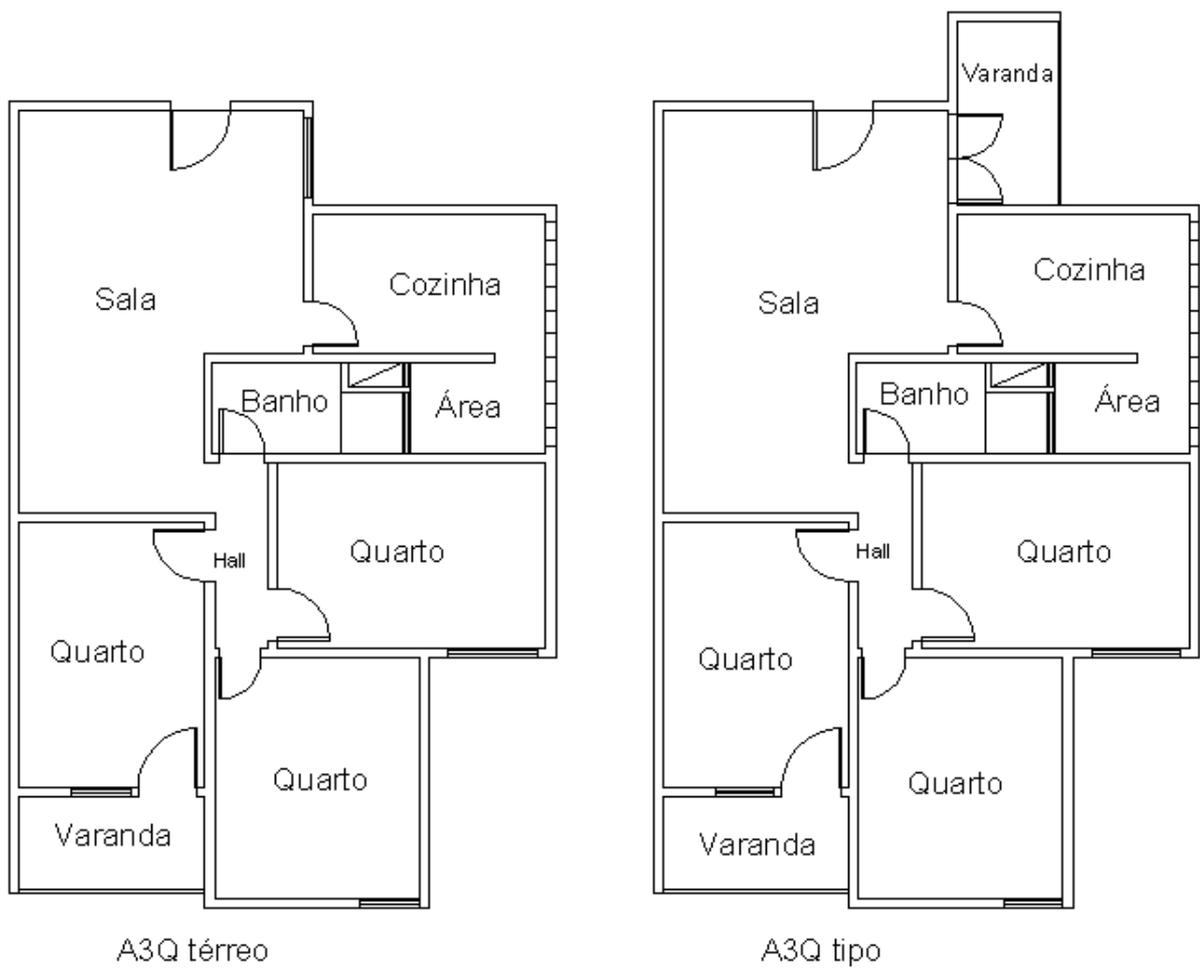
Planta baixa dos apartamentos de 3Q (térreo e tipo)
